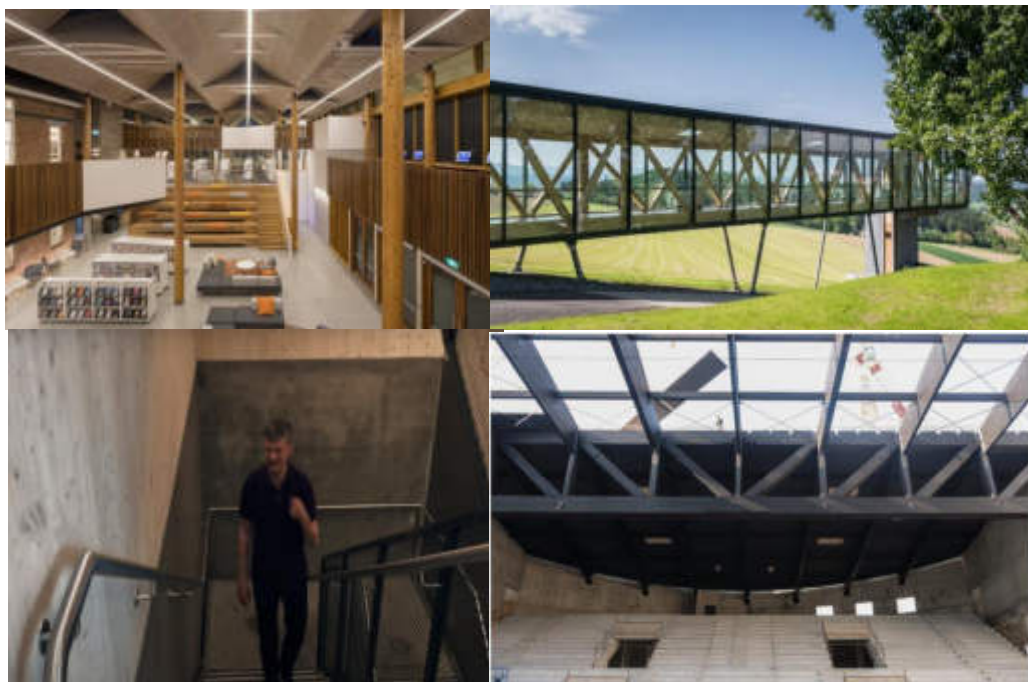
Зарубежный опыт совмещения древесины с простыми строительными материалами (бетон, железо, стекло)
